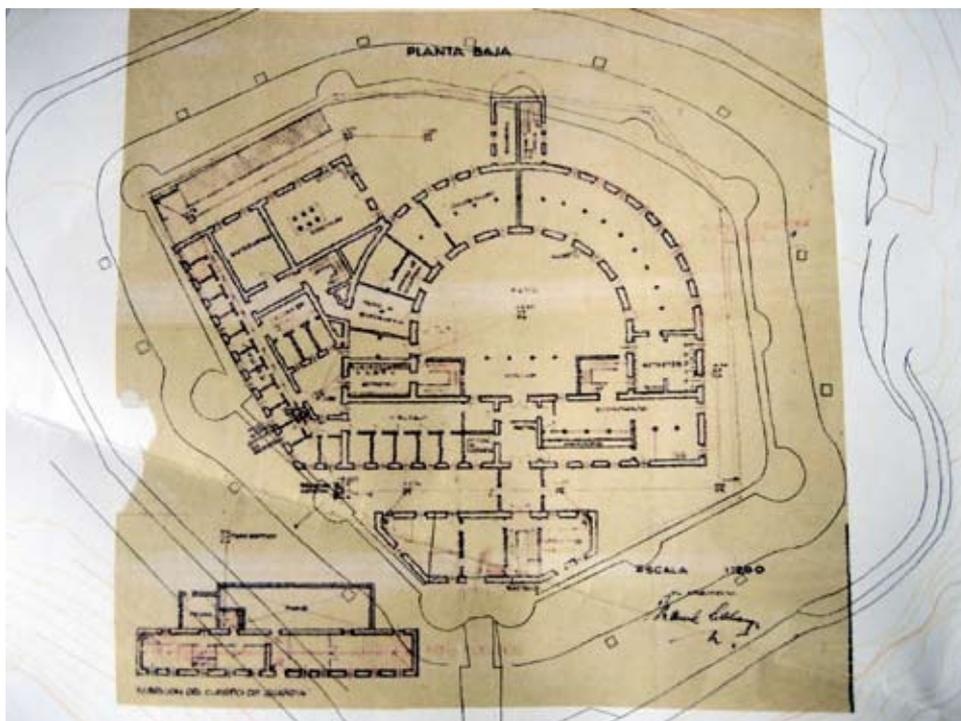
Planta del penal chinchillano sobre el recinto fortificado.
